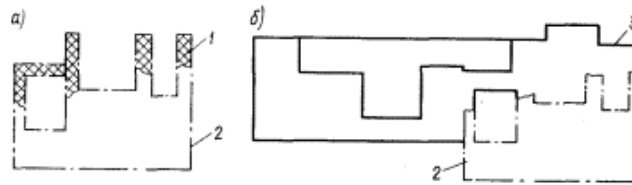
Фундамент с пристроенными новыми частями, а, б - фундамент до и после реконструкции соответственно; 1 - разрушаемая часть сущ. фундамента; 2 - используемая часть сущ. фундамента; 3 - новая часть фундамента
